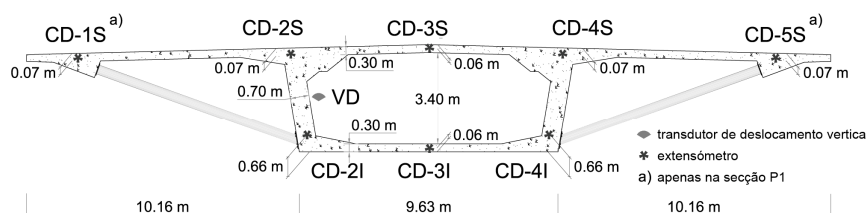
Instrumentação típica de uma secção transversal da ponte da Lezíria.
